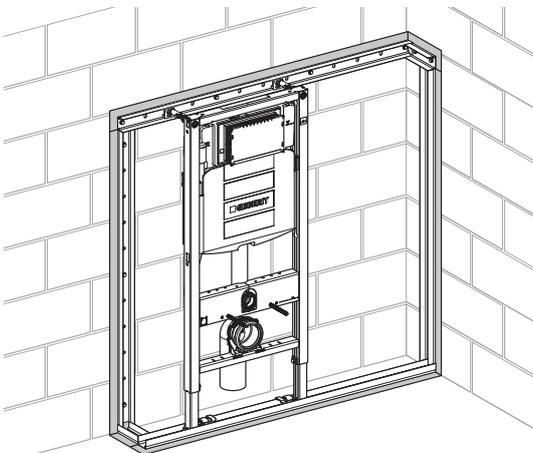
Teilhohe Vorwandinstallation, realisiert mit Geberit Duofix System
